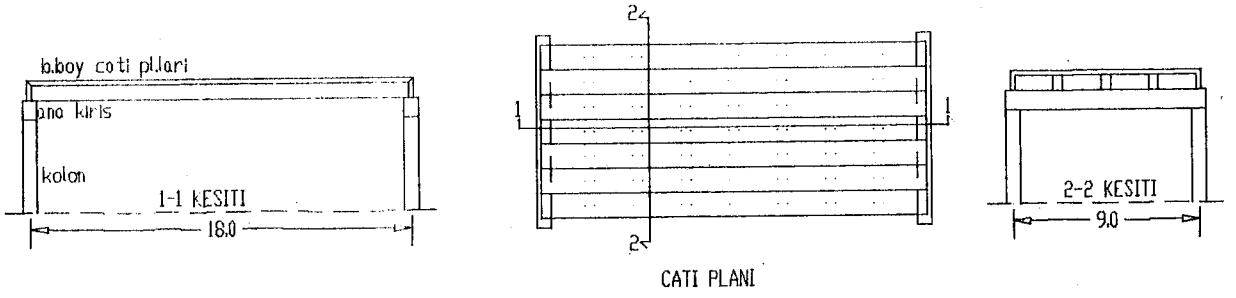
de aşıklar yerine açıklığın ortasına bir ara kiriş eklenmiş ve bu kirişin oturması için de, 9,0 m. açıklık geçen bağ kirişleri gerekmiştir. Sistemin üzerine, 1,0x4,5 m. boyutlarında plaklar oturtulmuştur. Bu çözümde 36 adet çatı plağı, 2 adet 18,0 m. lik, 1 adet 9,0 m. lik kiriş bulunmaktadır. Kiriş ağırlıkları birbirlerine yakın, çatı plaklarıysa daha hafiftir. Şekil 5.4. deki sakıncalar bu sistem için de geçerlidir. Bu tür bir sistem kuruluşu, düz çatılardan çok, şed aralıklarını küçültmek amacı ile, şed kirişli çatılarda uygulanmaktadır.
